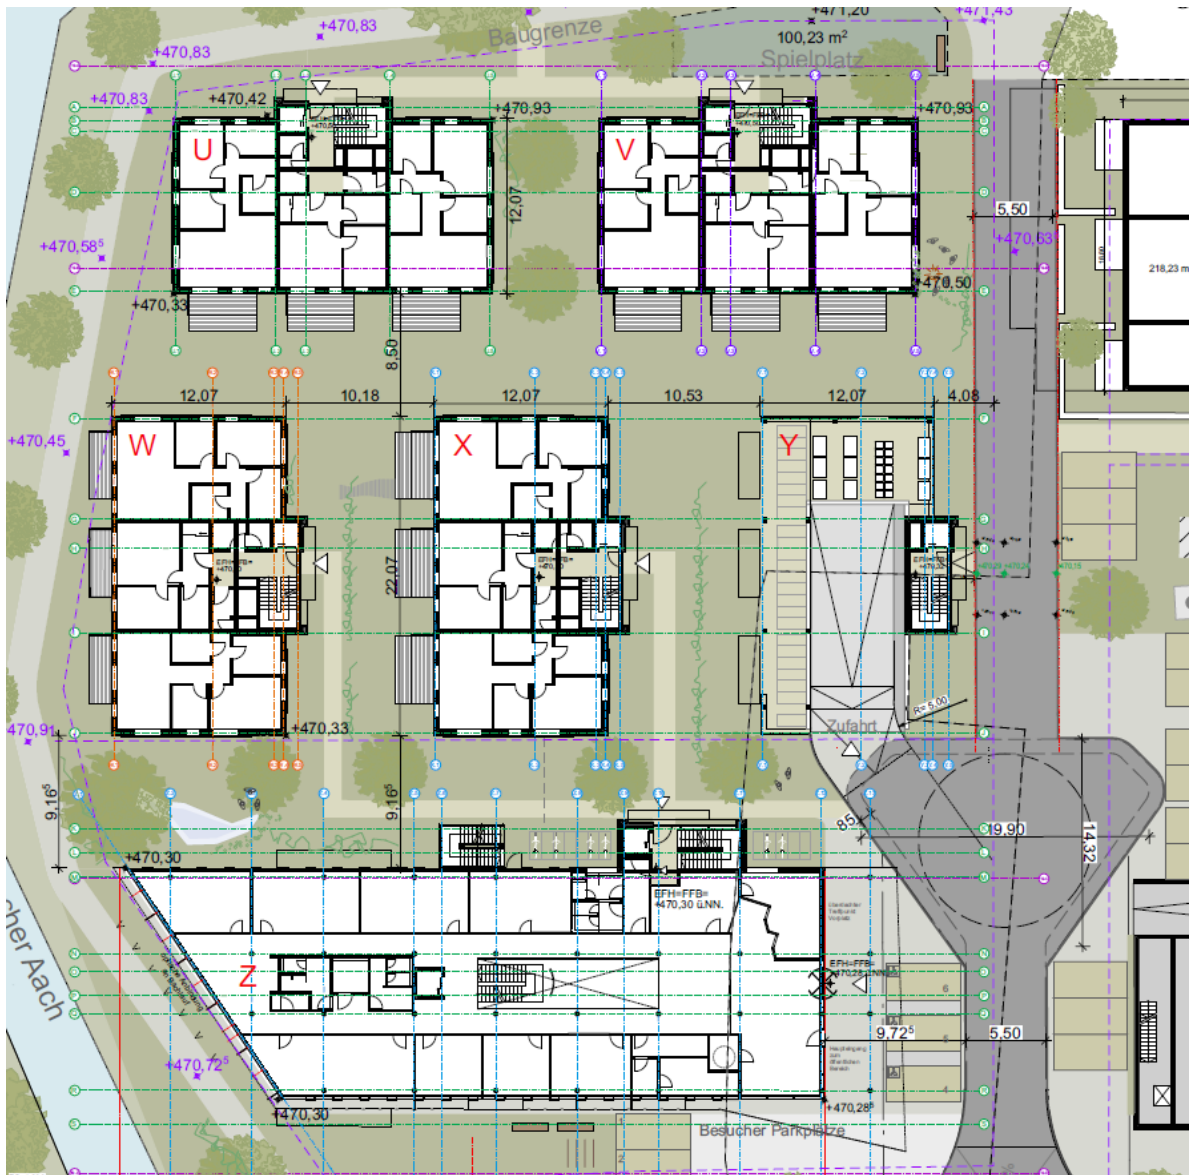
Westlicher Bereich – Grundriss Erdgeschoss (dp Daschmann Planungsgesellschaft mbH, Stand 11/2021)
